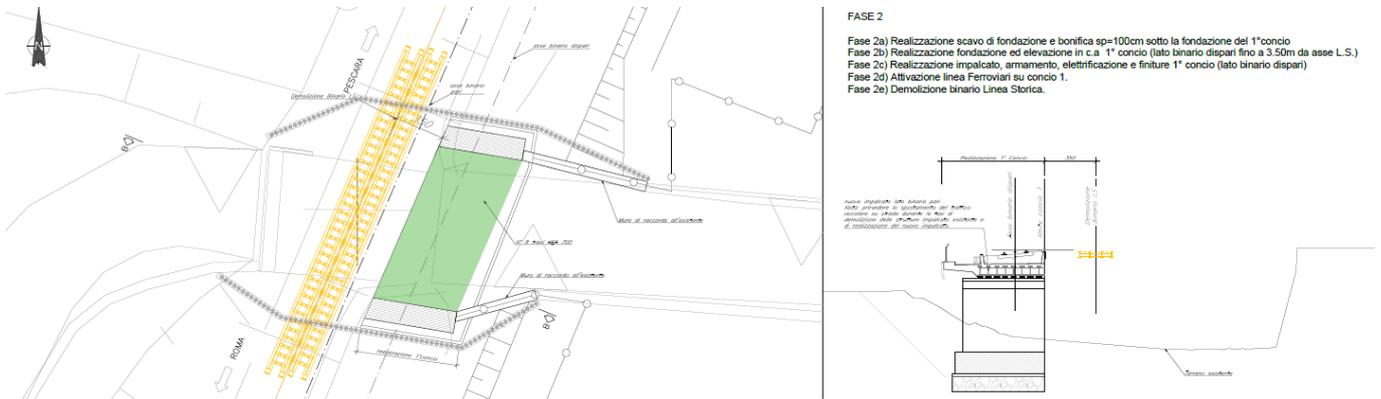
SL26 – Fase realizzativa 2, pianta e sezione sottopasso
